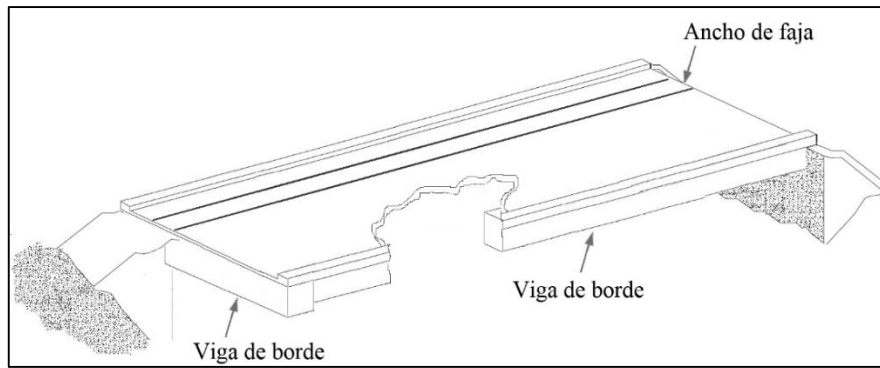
Ancho de Franja en losa con acero de refuerzo paralelo al tránsito.
